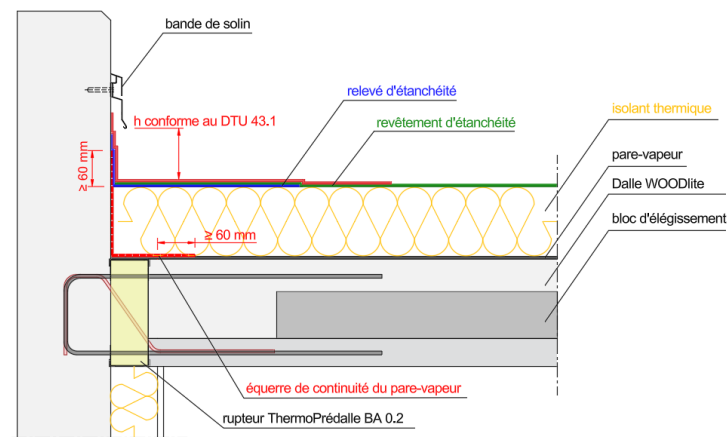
exemple de disposition d'étanchéité en toiture-terrasse
